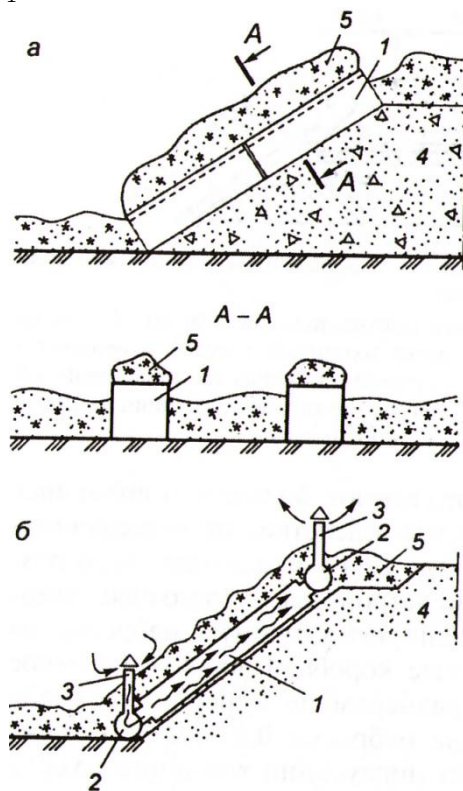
Устройство вентиляционных коробов на откосе земляного полотна: а – без вентиляционных коллекторов; б – с вентиляционными коллекторами. 1 – вентиляционный короб; 2 – вентиляционный коллектор; 3 – вентиляционная шахта; 4 – земляное полотно; 5 – снежный покров
